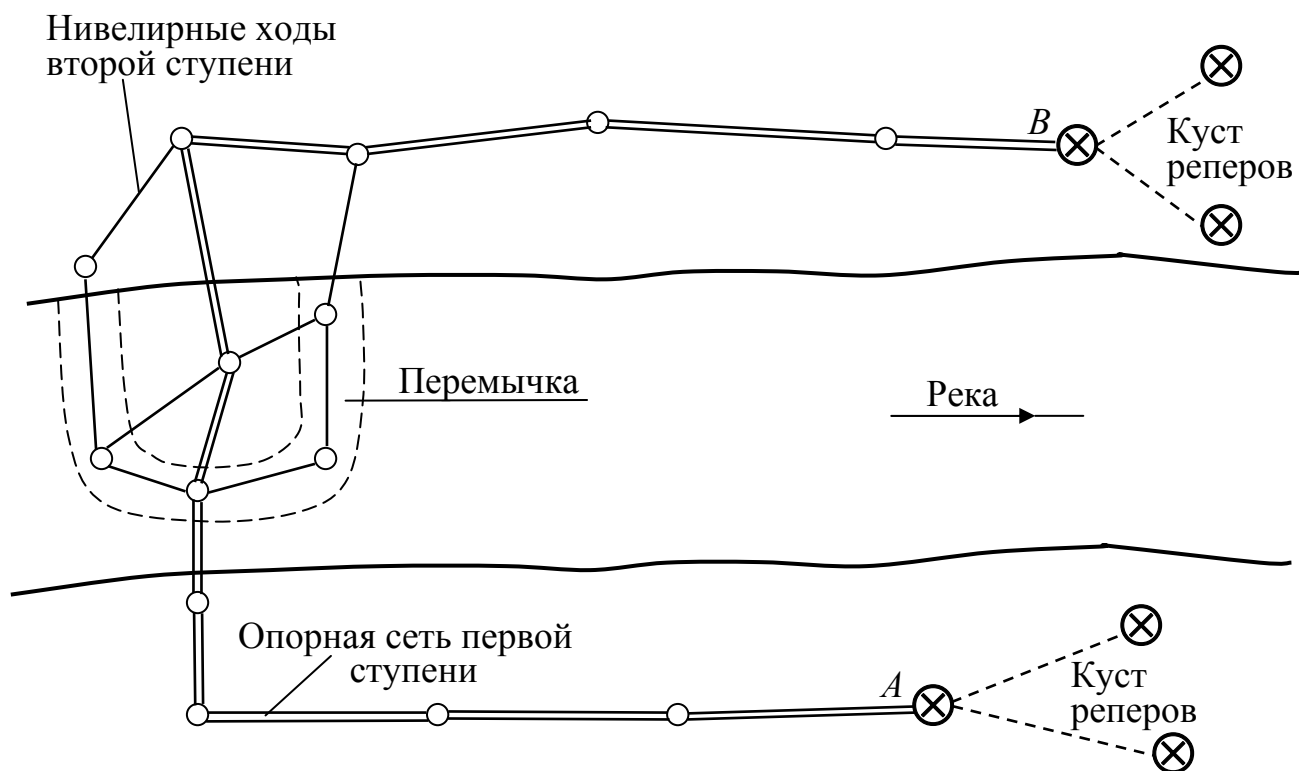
Высотная опорная сеть для строительства гидроузла
